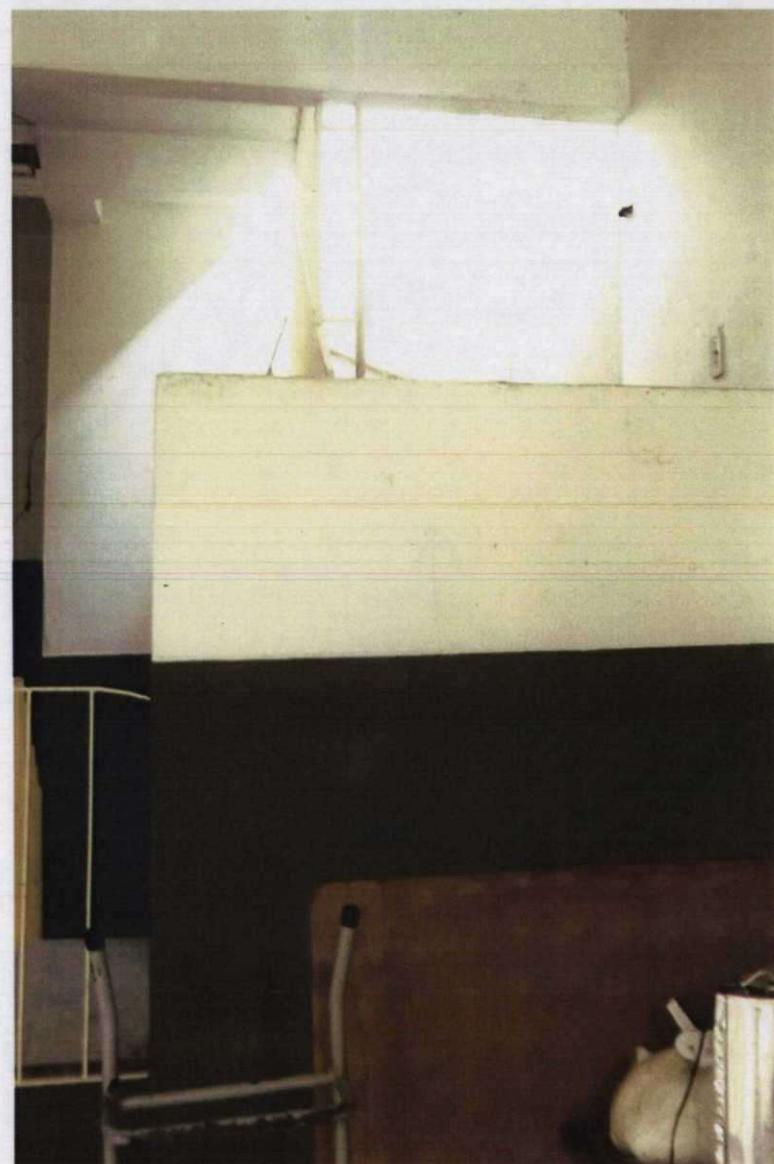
MURETA DE PROTEÇÃO NO PATAMAR DA ESCADA
